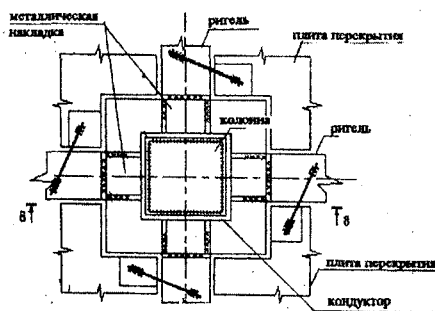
Узел опирания ригелей на колонну и узловой элемент
